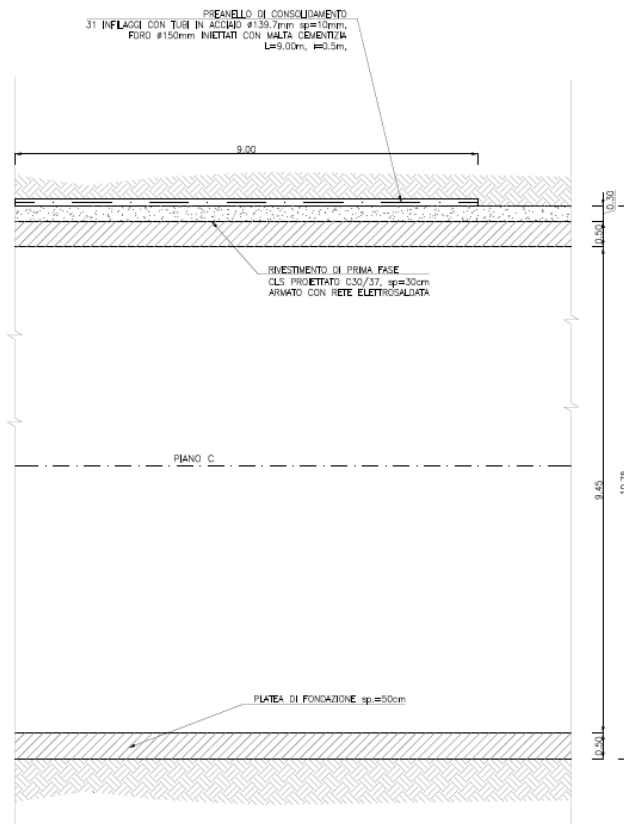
Sezione tipo GV-Imb: geometria del cavo e interventi di sostegno, sezione longitudinale
